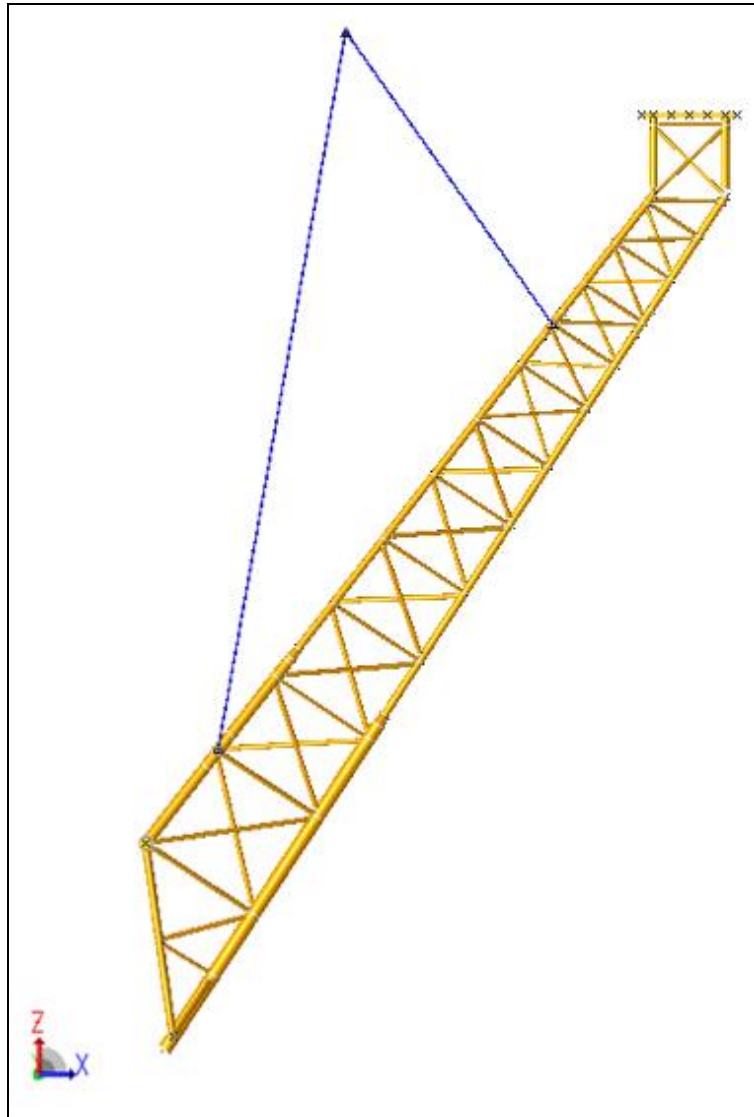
Fiaccola Modello Strutturale – Posizione Verticale Vista Laterale
